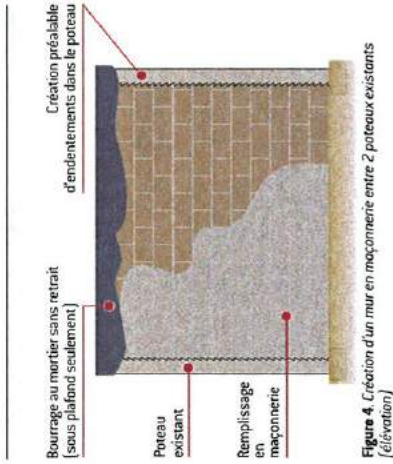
Création d'un mur en maçonnerie entre 2 poteaux existants (élévation)
